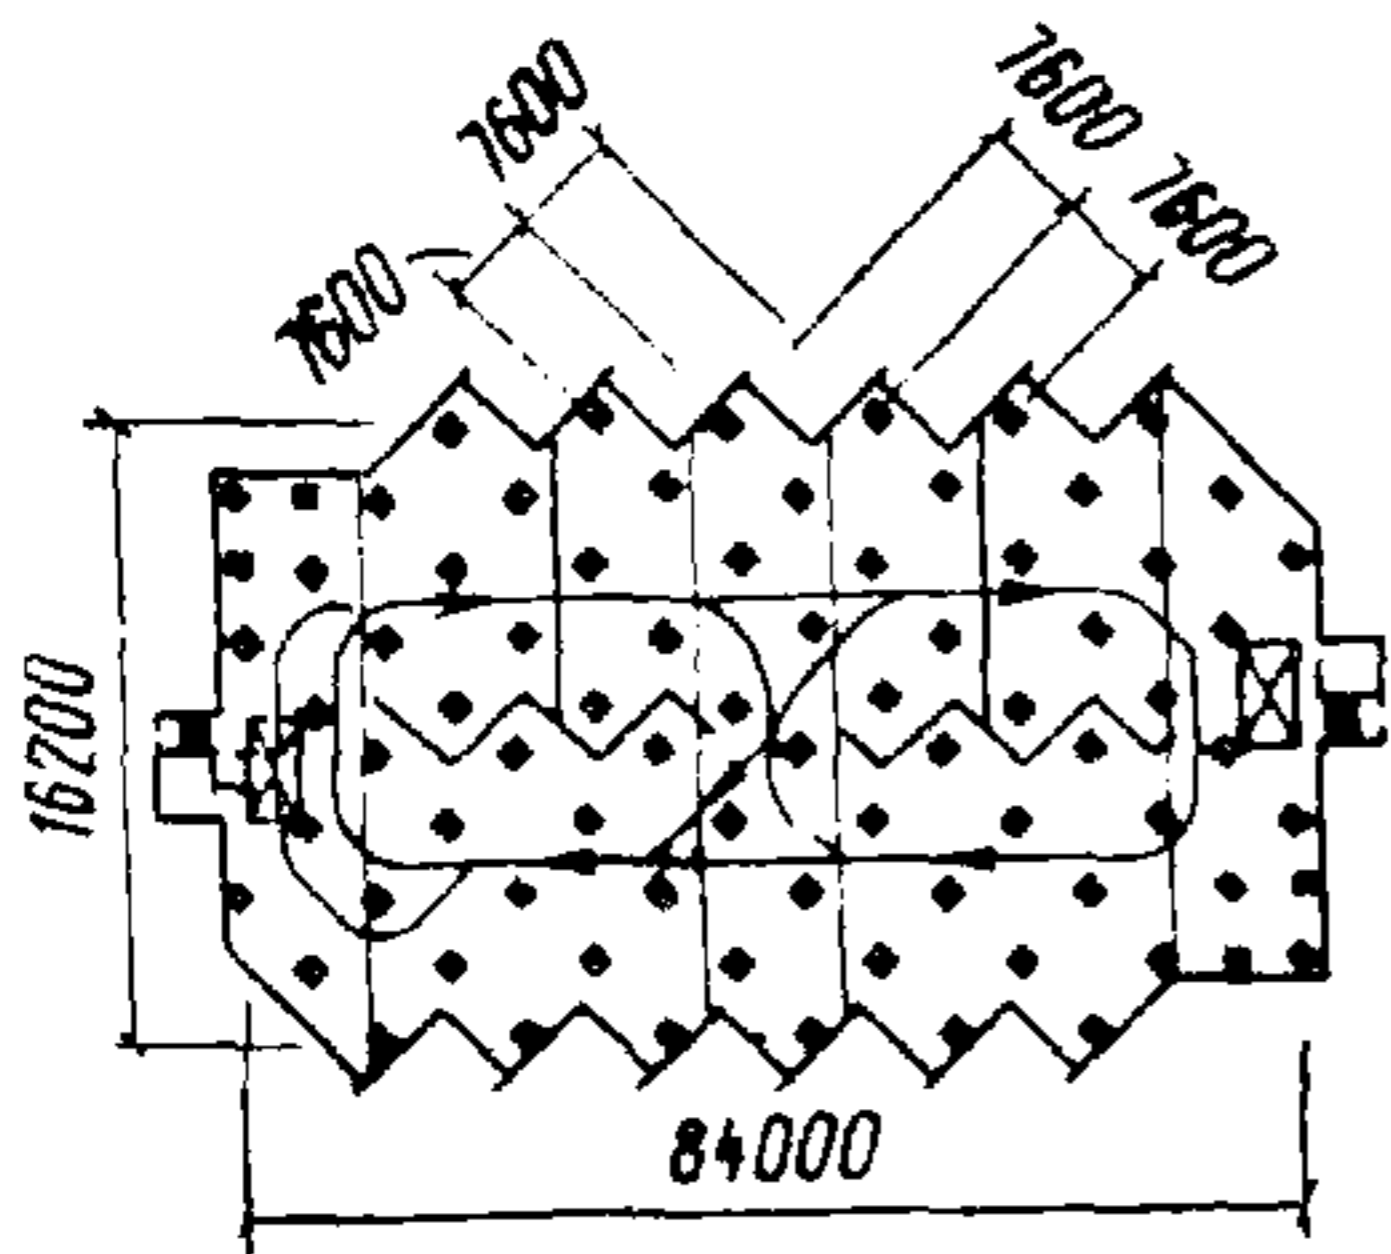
План типового этажа гаража-стоянки на 1100 легковых автомобилей (Моспроект-2 при участии ЦНИИпромзданий)
